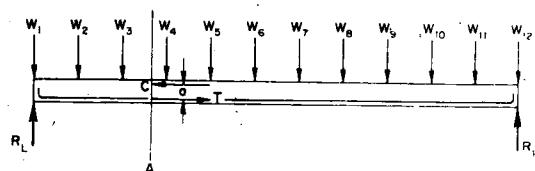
鋼筋混凝土，由於混凝土的抗拉能力很差，故必須以鋼筋加強，才能抵抗彎曲。在鋼筋混凝土中，混凝土承受彎曲所造成的壓力，而鋼筋則承受彎曲所造成的拉力
